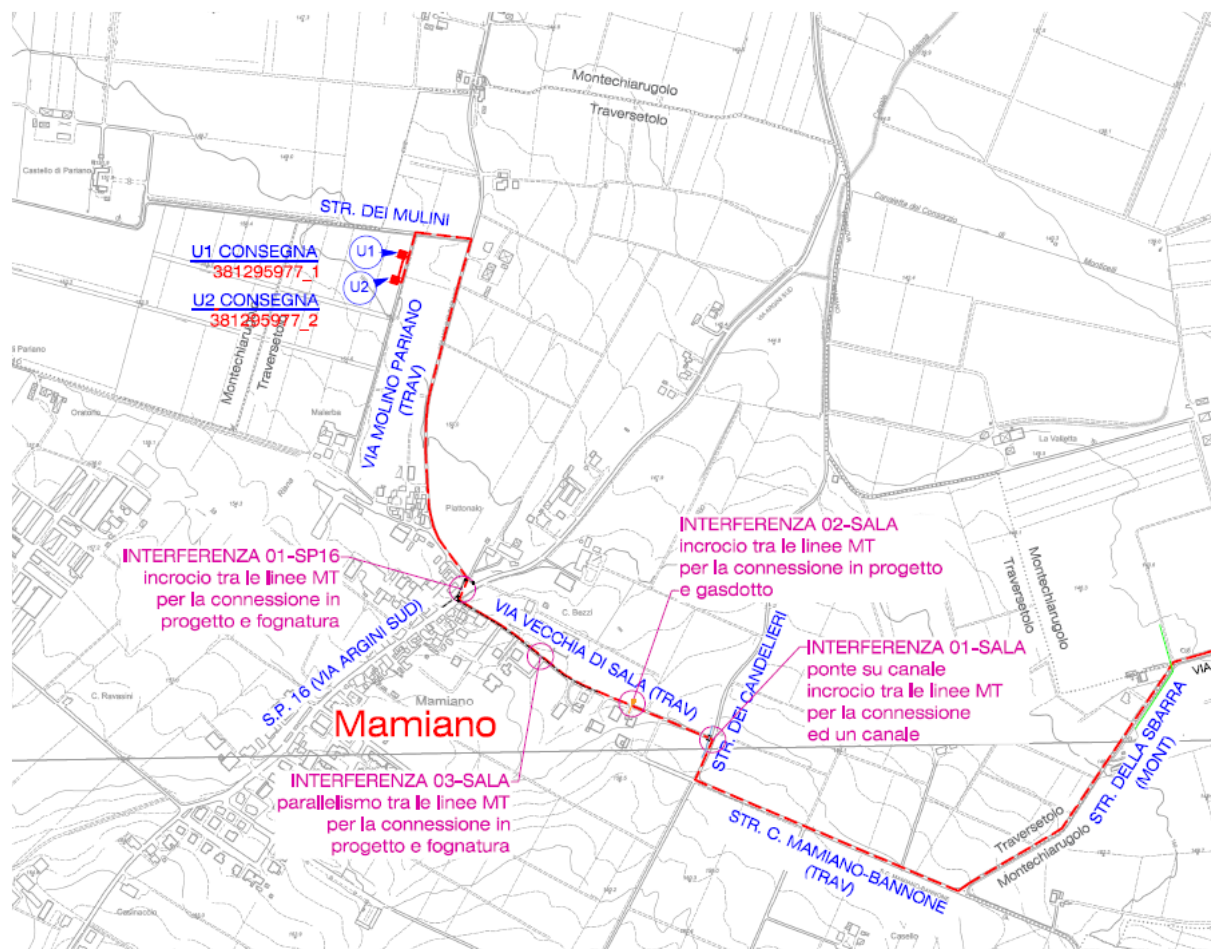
Stralcio planimetria dalle cabine di consegna verso la cabina primaria (primo tratto)
